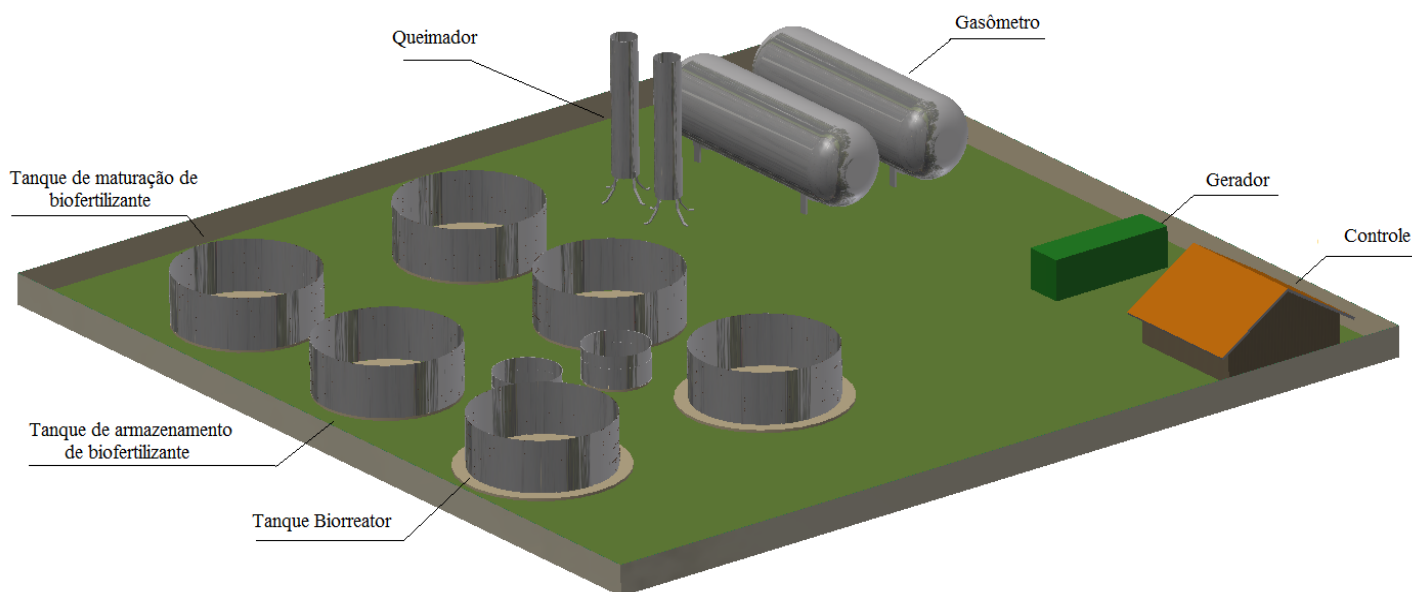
Planta de biodigestão em modelagem 3D.
